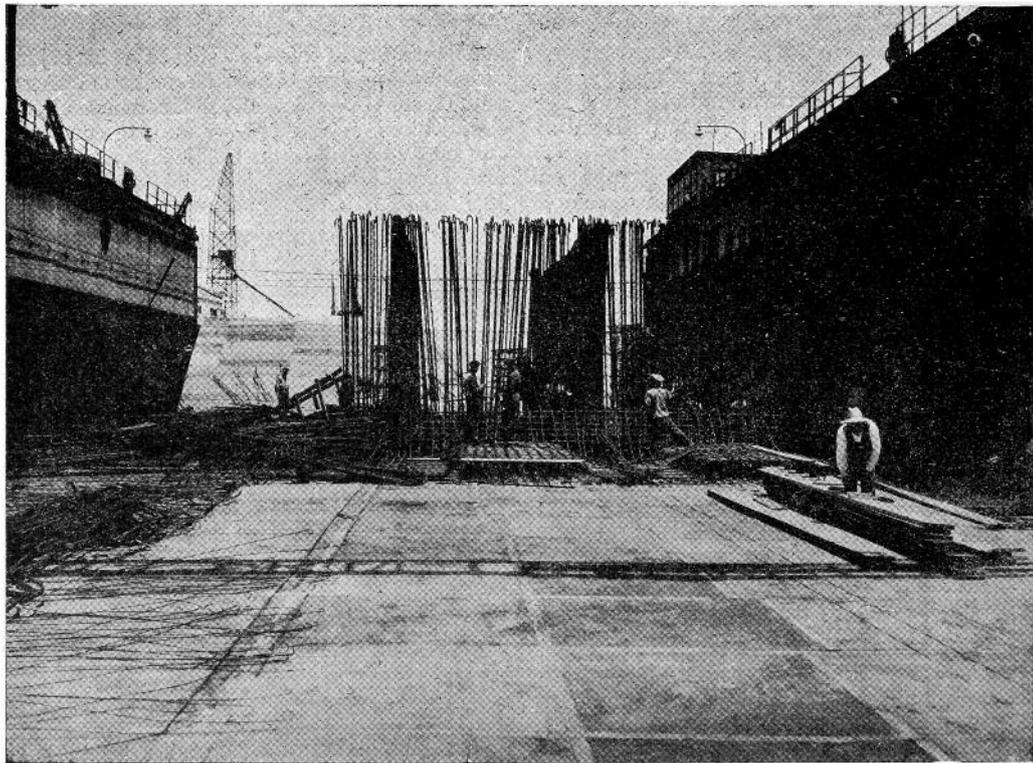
Montaje de la armadura de uno de los grandes cajones sobre el plan del dique flotante ya preparado para el encofrado del fondo
